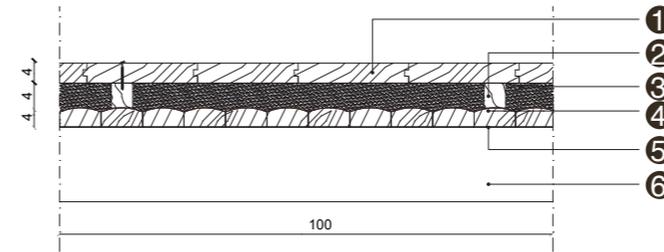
Dettaglio tecnologico solaio Secondo piano. Scala 1:10
